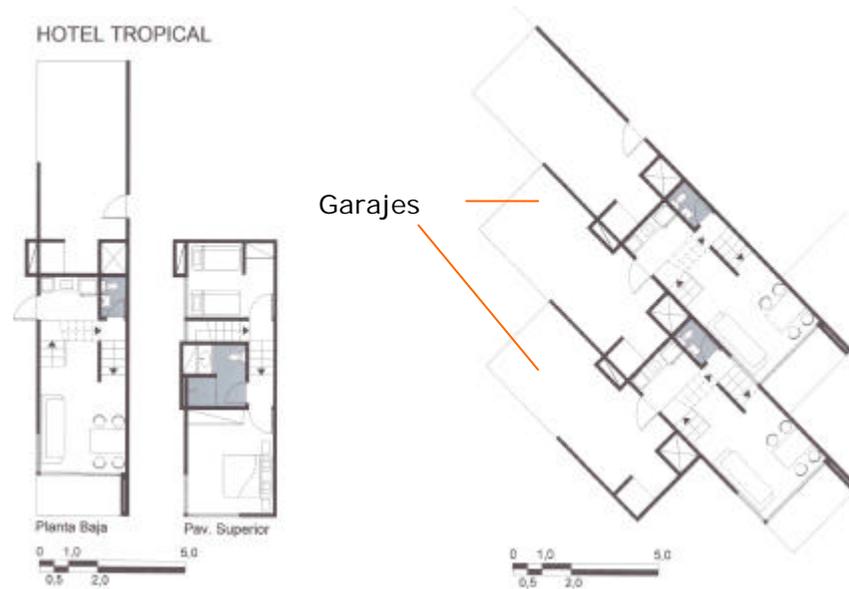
Plantas Bajas y sistema de acoplamiento a 45°.
